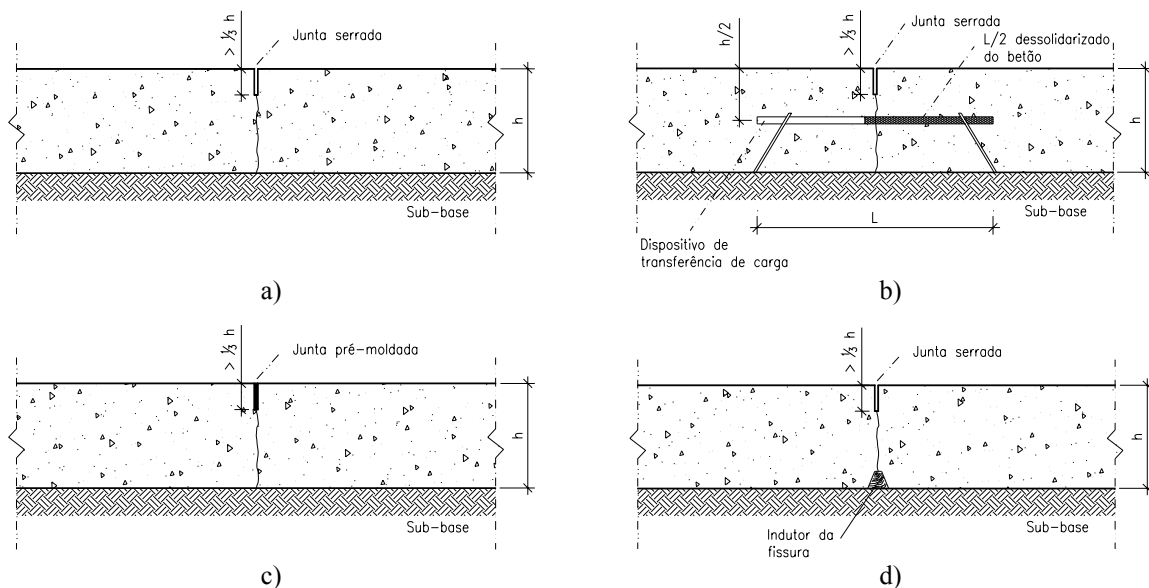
Tipos de juntas de controlo da fendilhação: a) Junta serrada; b) Junta serrada e ferrolhada; c) Junta pré-moldada; d) Junta serrada auxiliada por um indutor de fenda
